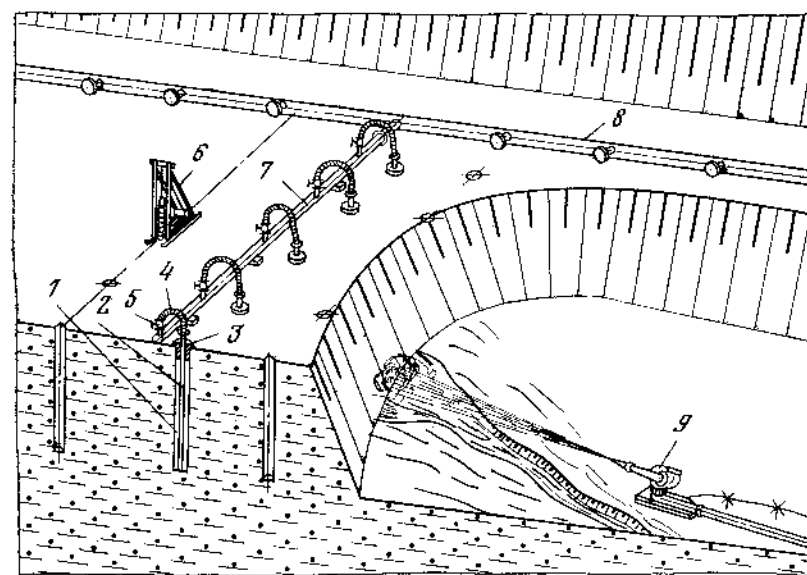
Схема предварительного водонасыщения породы при гидромониторной разработке:
